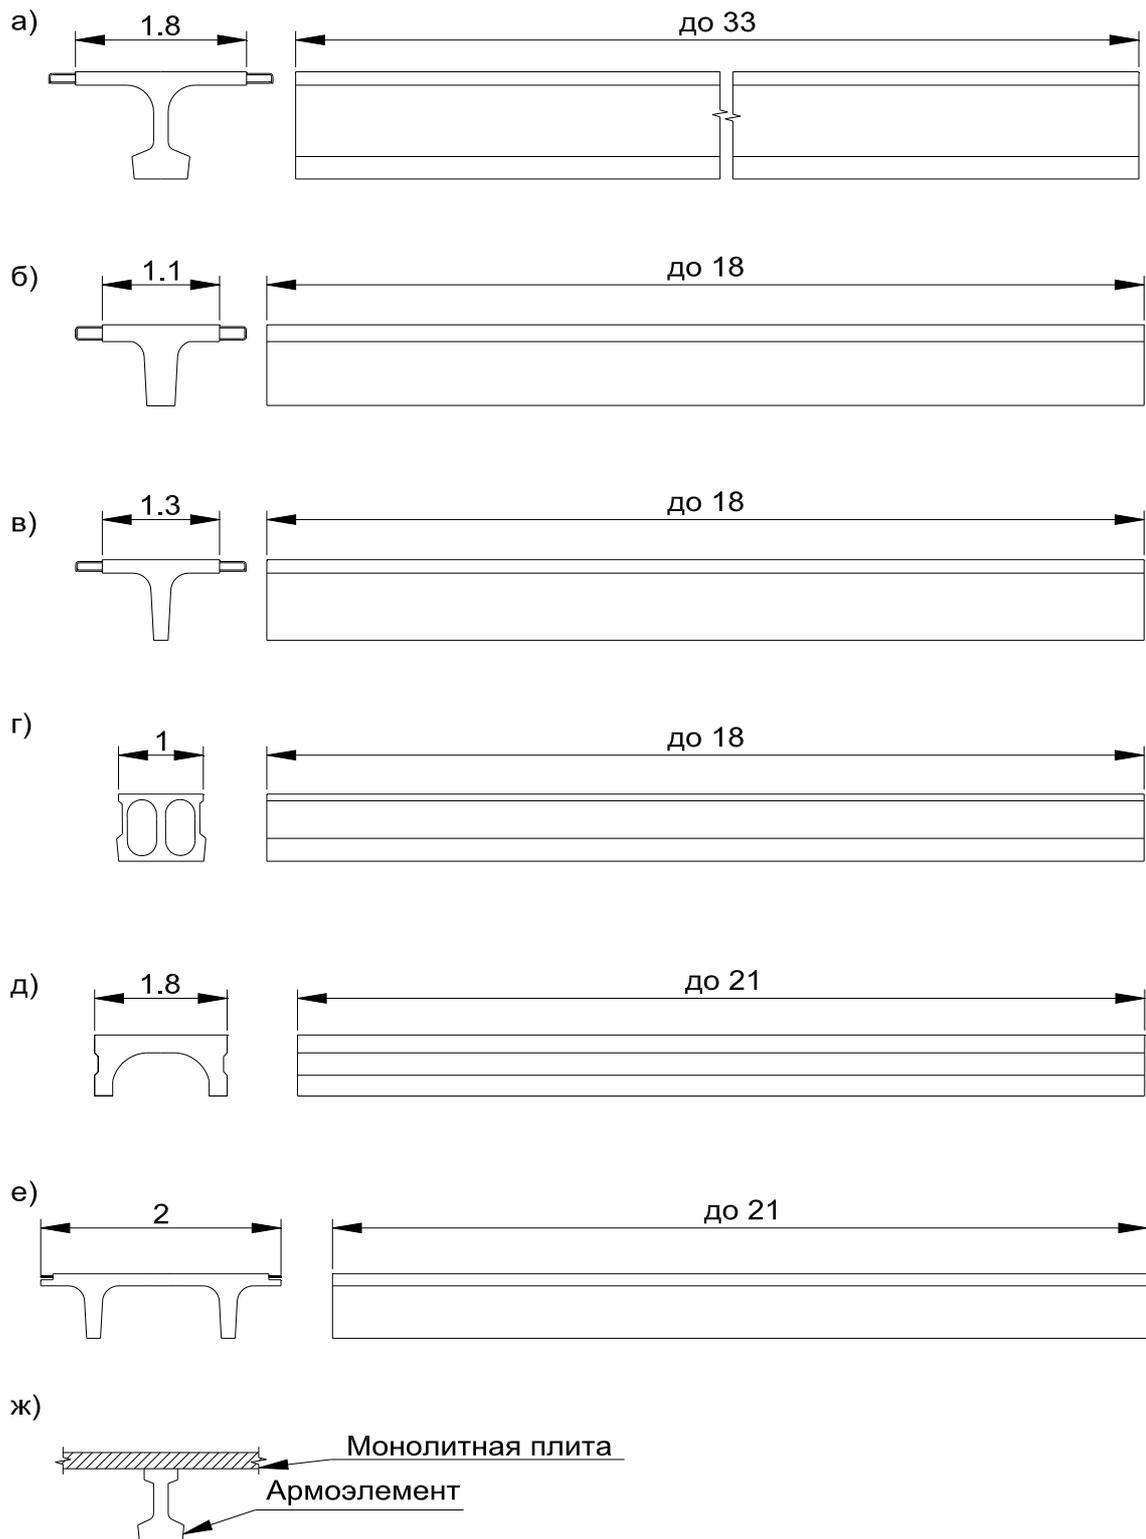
Конструкция цельноперевозимых балок и плит:
